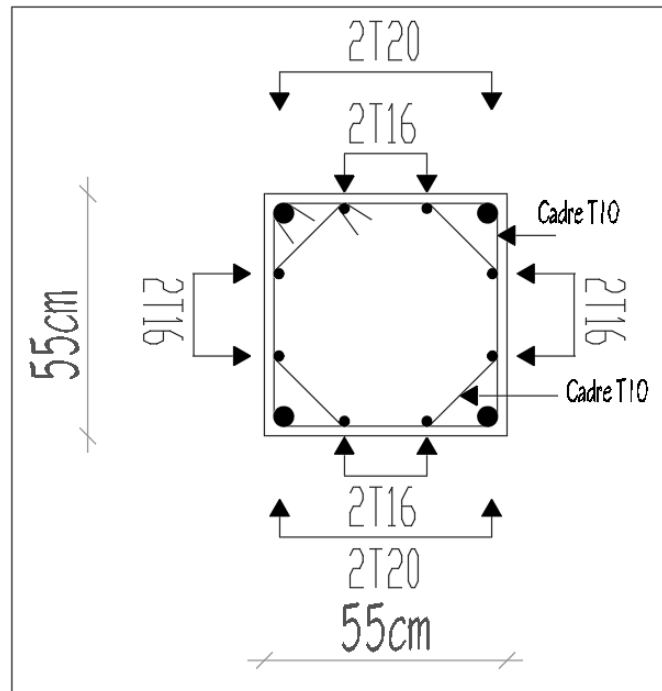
le schéma de ferraillage des poteaux 55*55
